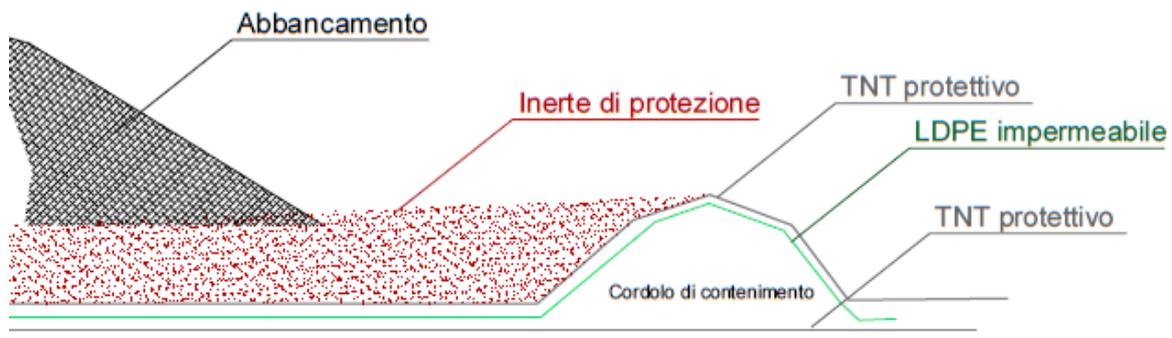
Schema di predisposizione fondo impermeabile delle baie rifiuti
